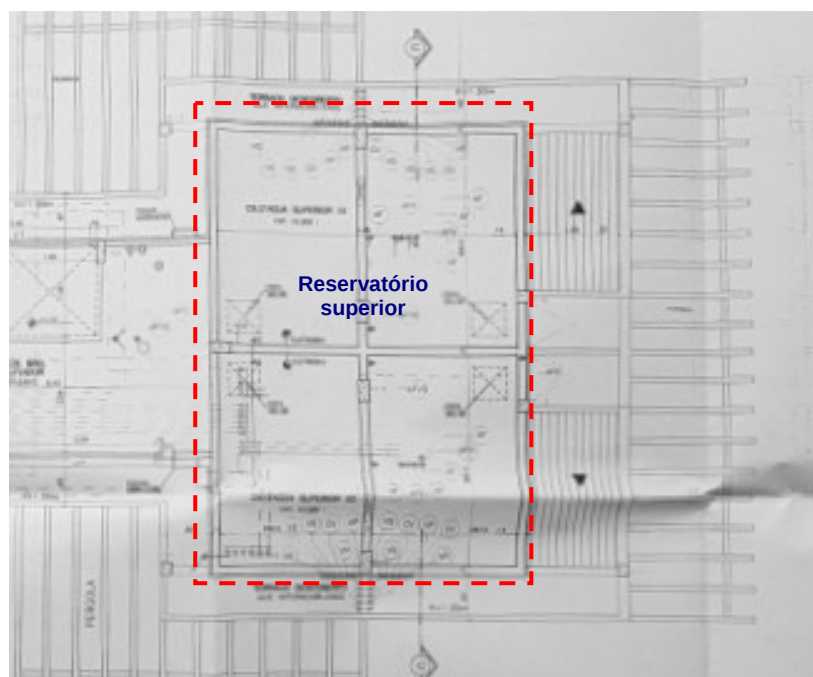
Planta baixa trecho pavimento de cobertura que contém o reservatório superior.
